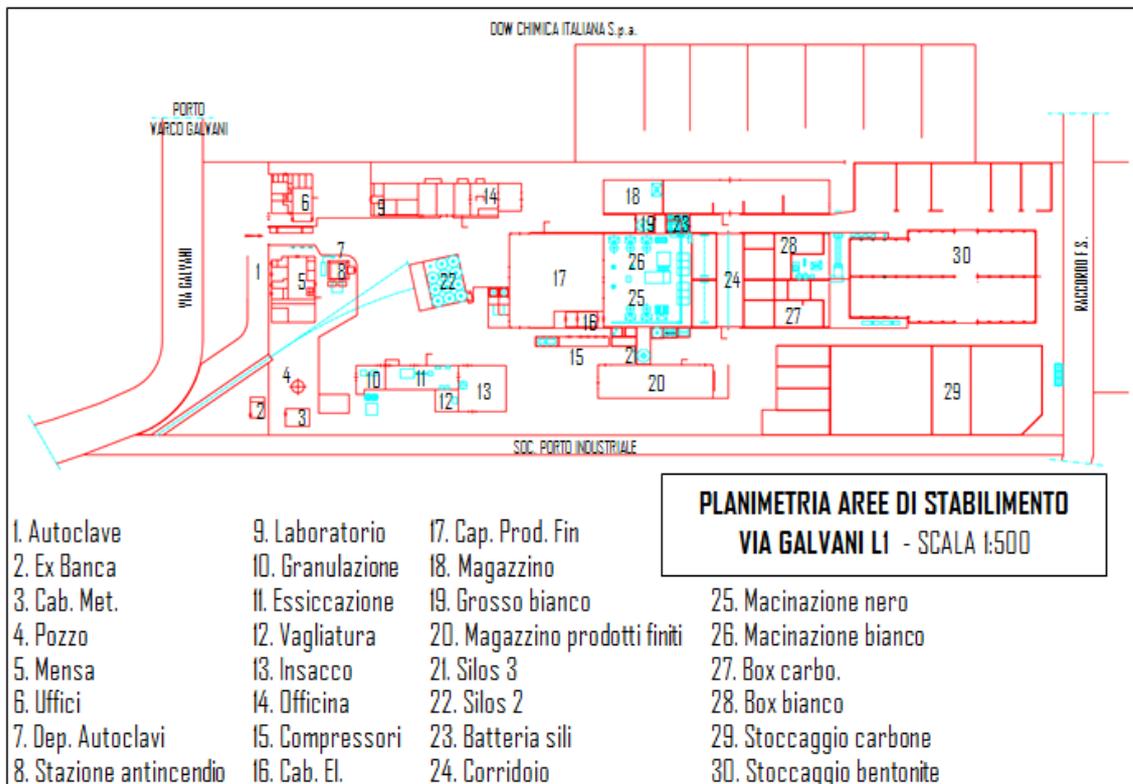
Planimetria aree di stabilimento Via Galvani L1
